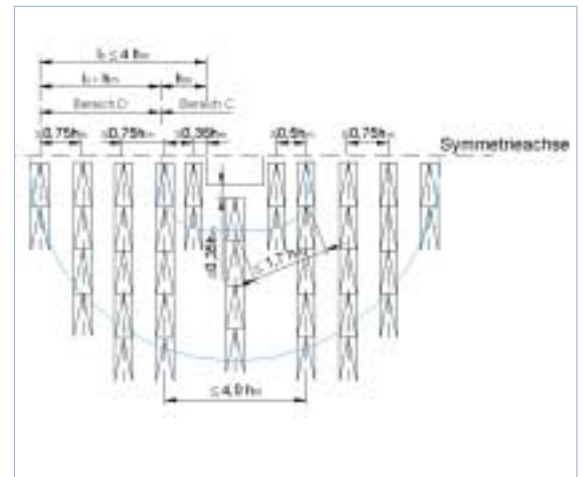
Maximale Abstände der Filigran-Durchstanzbewehrung
